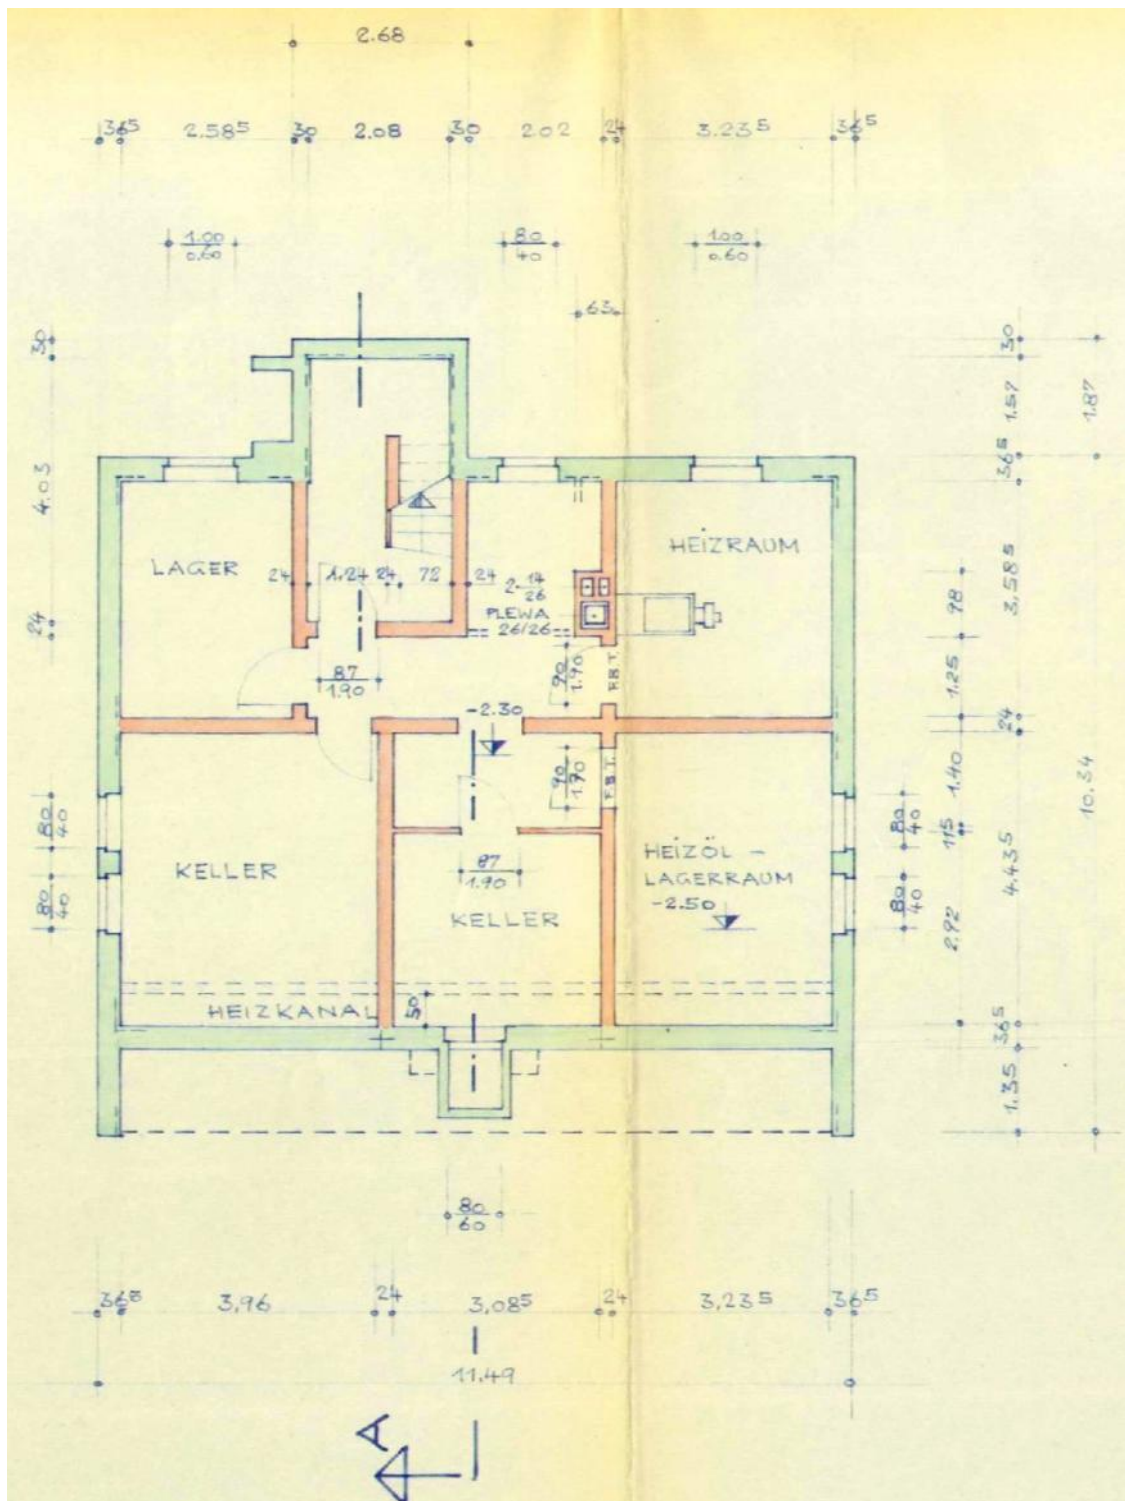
Grundrissplan Kellergeschoss des Ursprungsgebäudes (aus Bauakte 1962)
